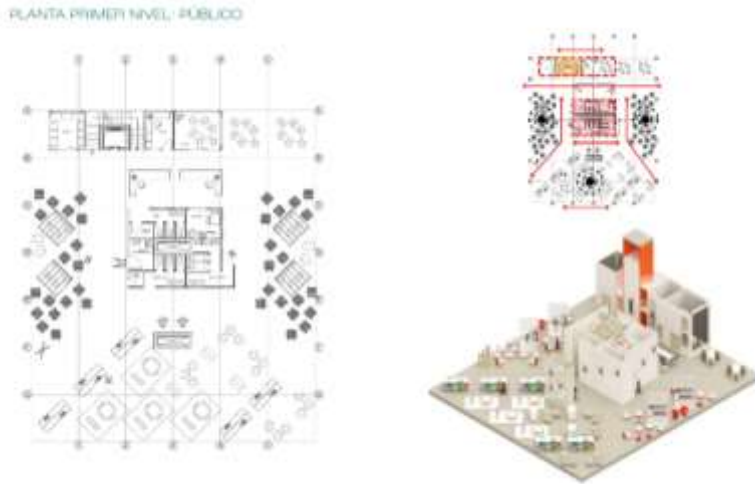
Propuesta planta primer nivel de espacio público de la agrupación. Autoría propia (2020)
